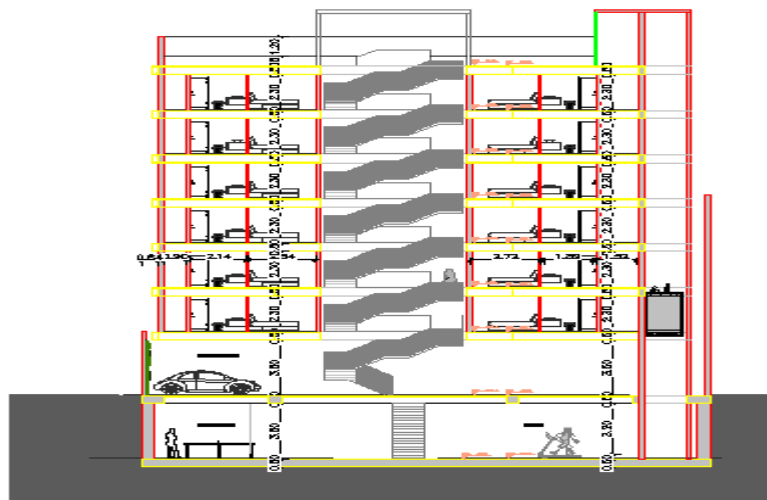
PLANO ARQUITECTÓNICO DEFINITIVO – ASL01.
